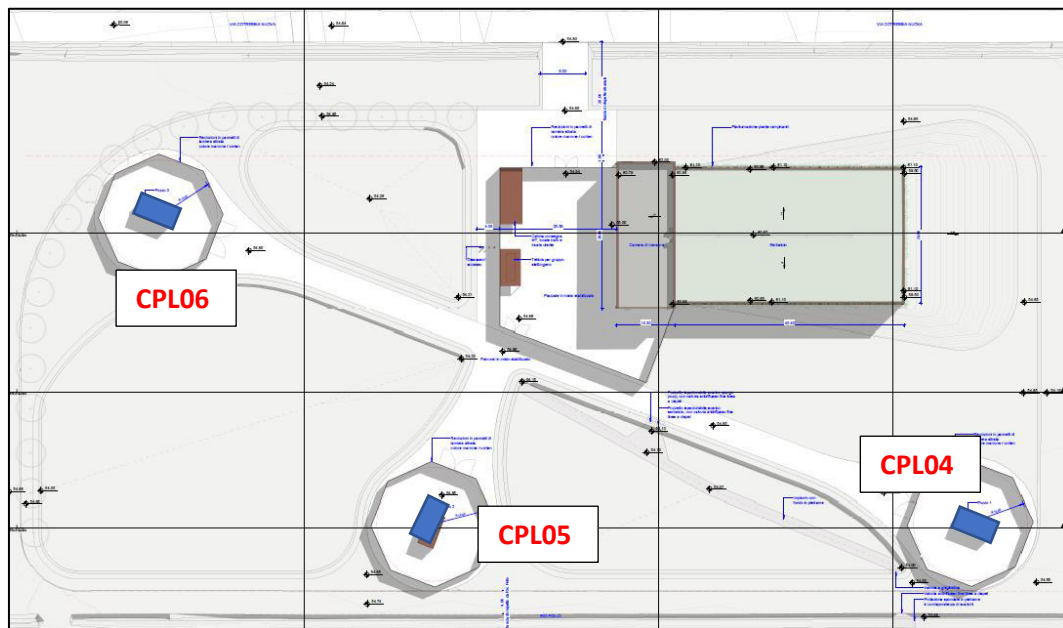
Planimetria centrale con in blu i pozzi in progetto.
